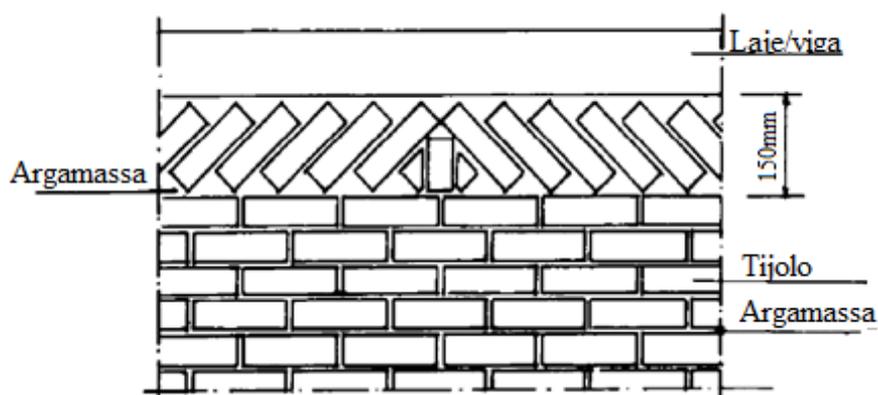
Travamento entre alvenaria e estrutura com cunhas de concreto pré-fabricadas.
